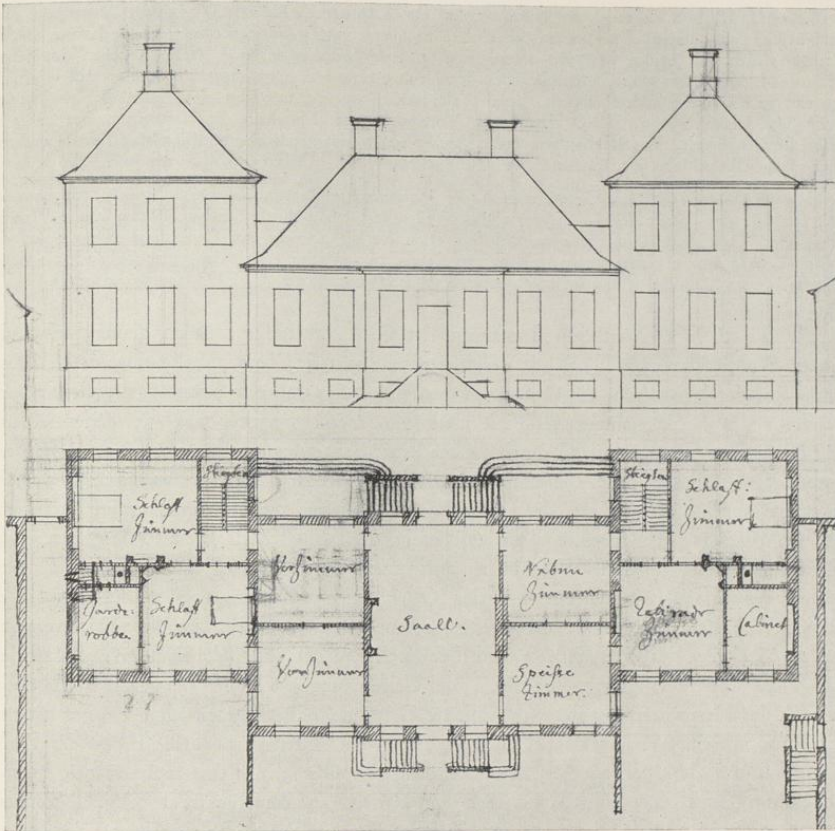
Aufriß und Grundriß des Hauptgeschosses der Friedrichsburg
